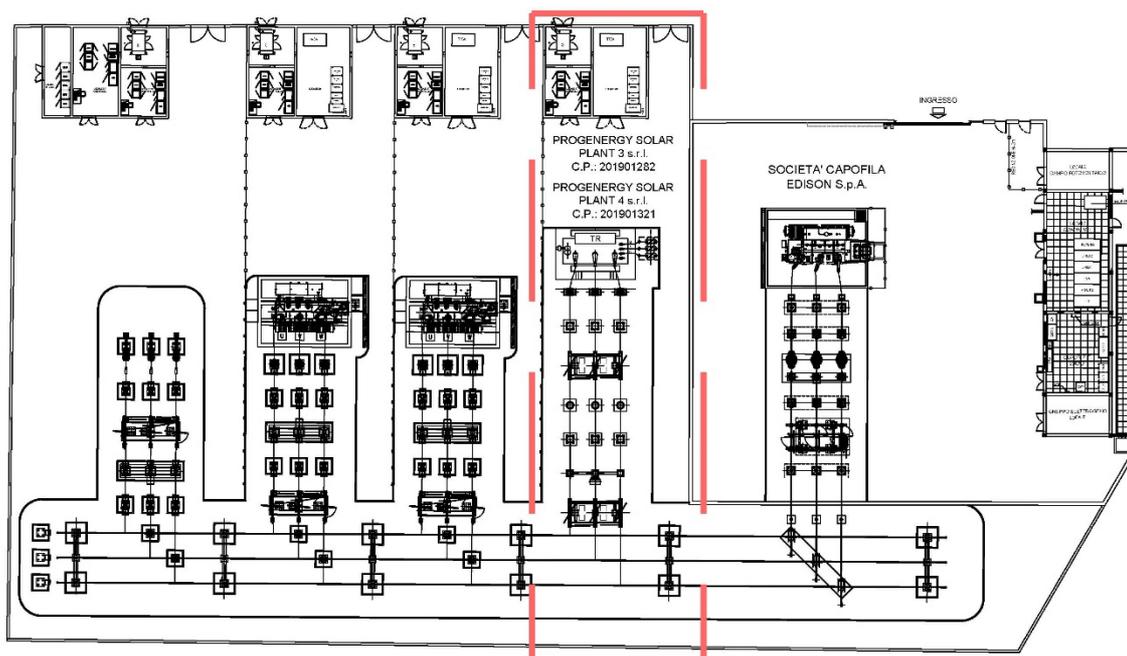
Planimetria della Stazione Elettrica Utente condivisa 150/30 kV
